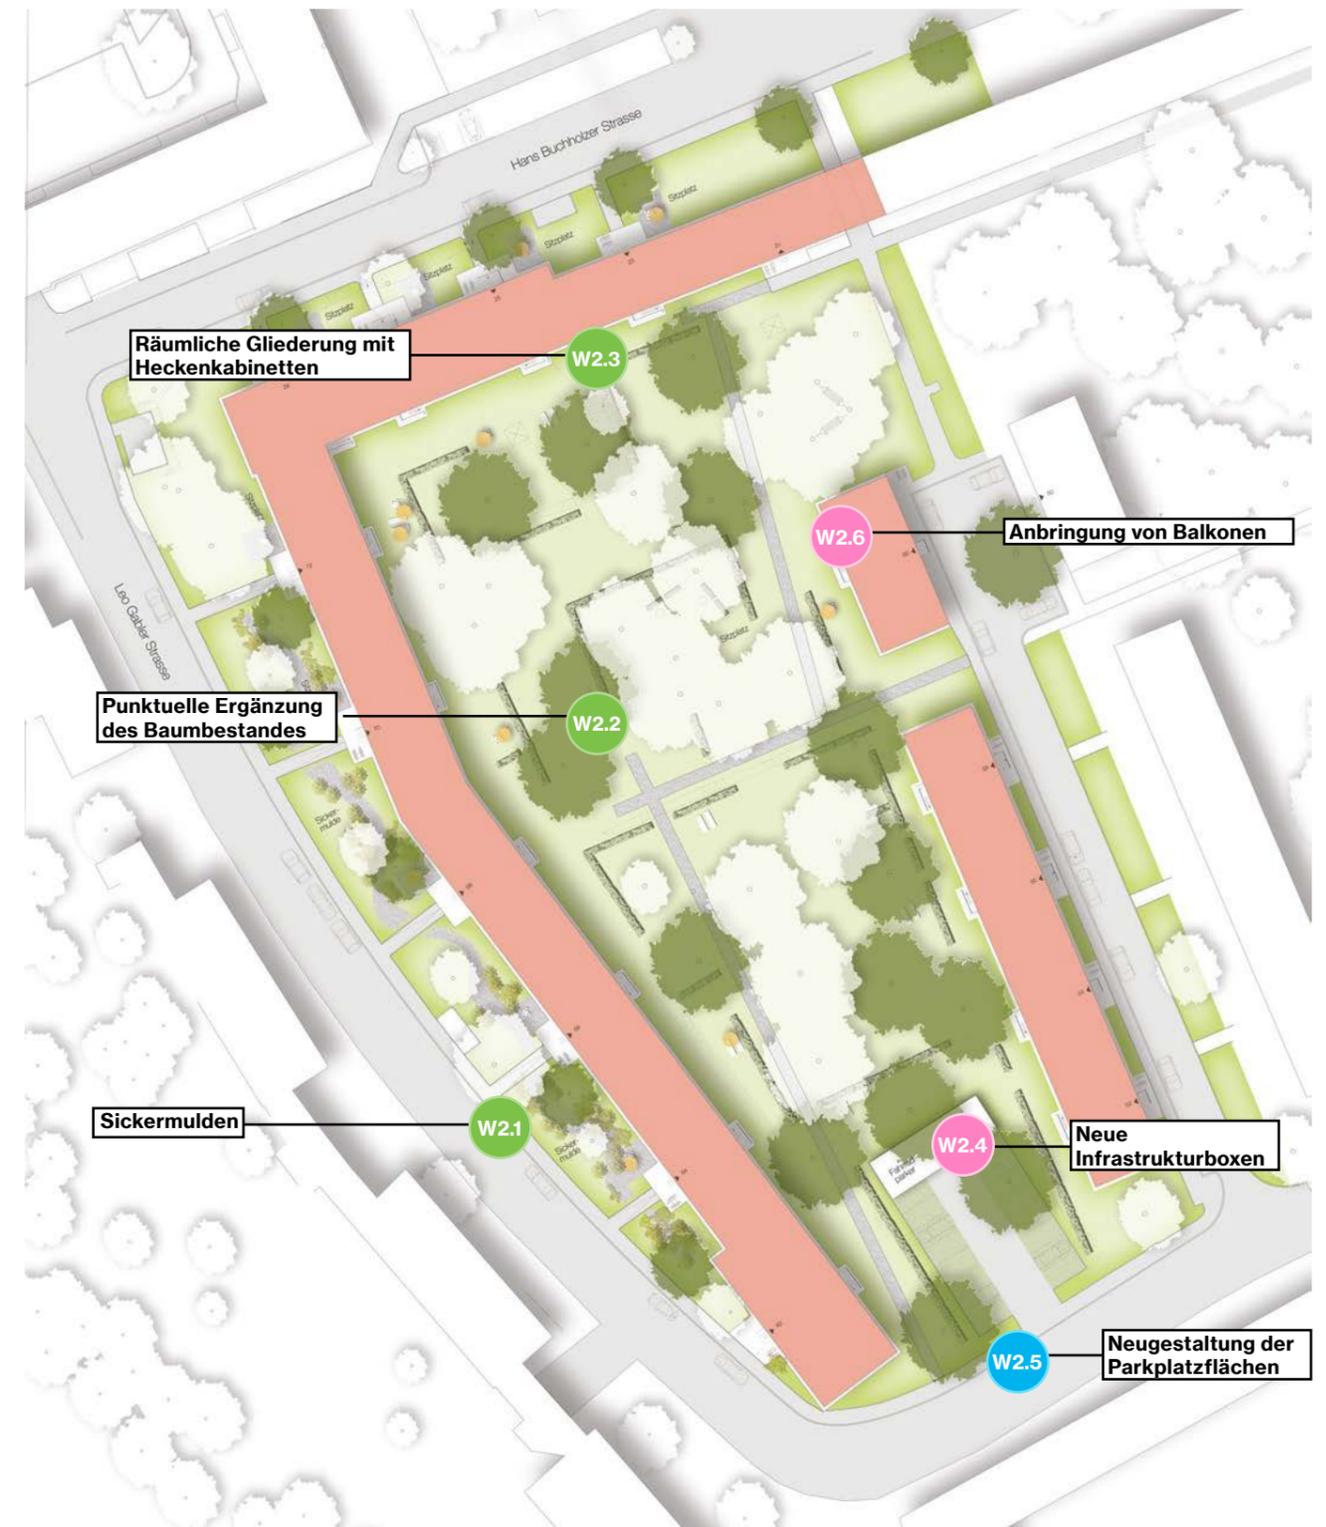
Detailplan Prototyp Leo-Gabler-Straße, Darstellung: DnD Landschaftsplanung ZT KG
